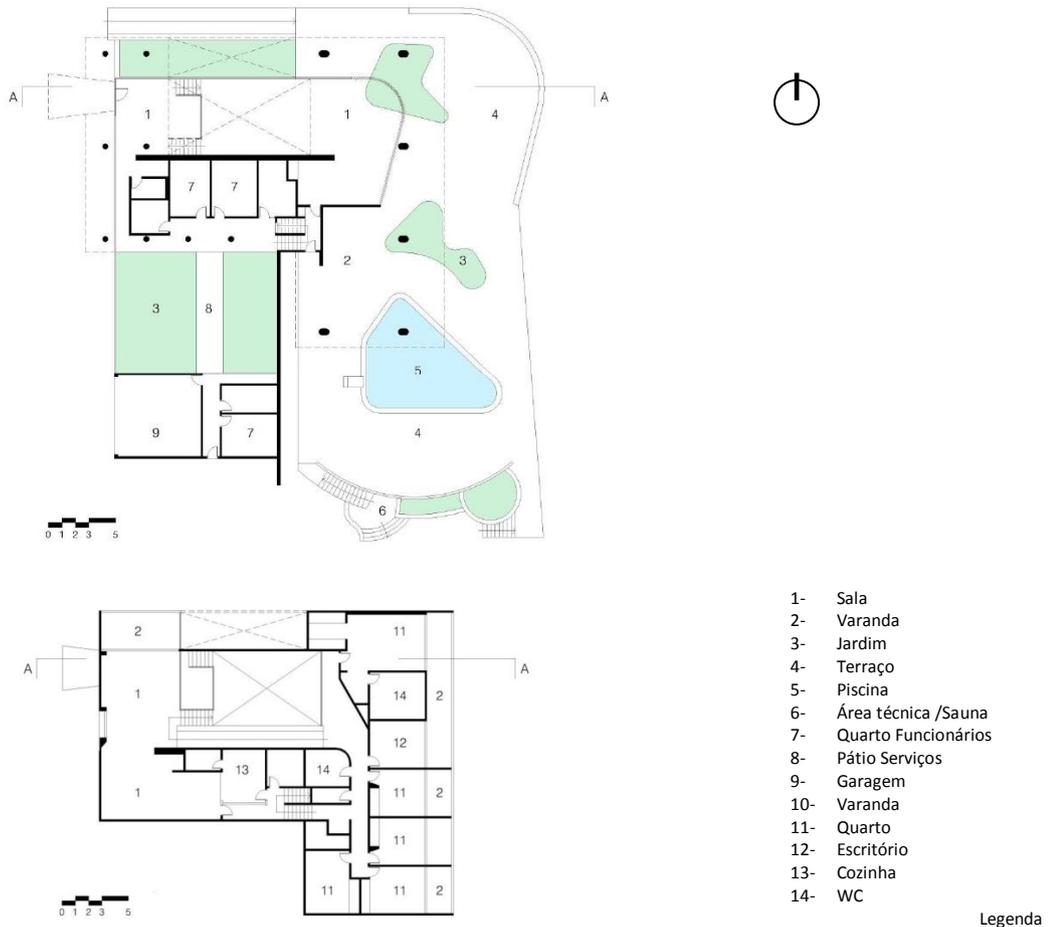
Planta Piso Térreo e Planta Piso Superior.
